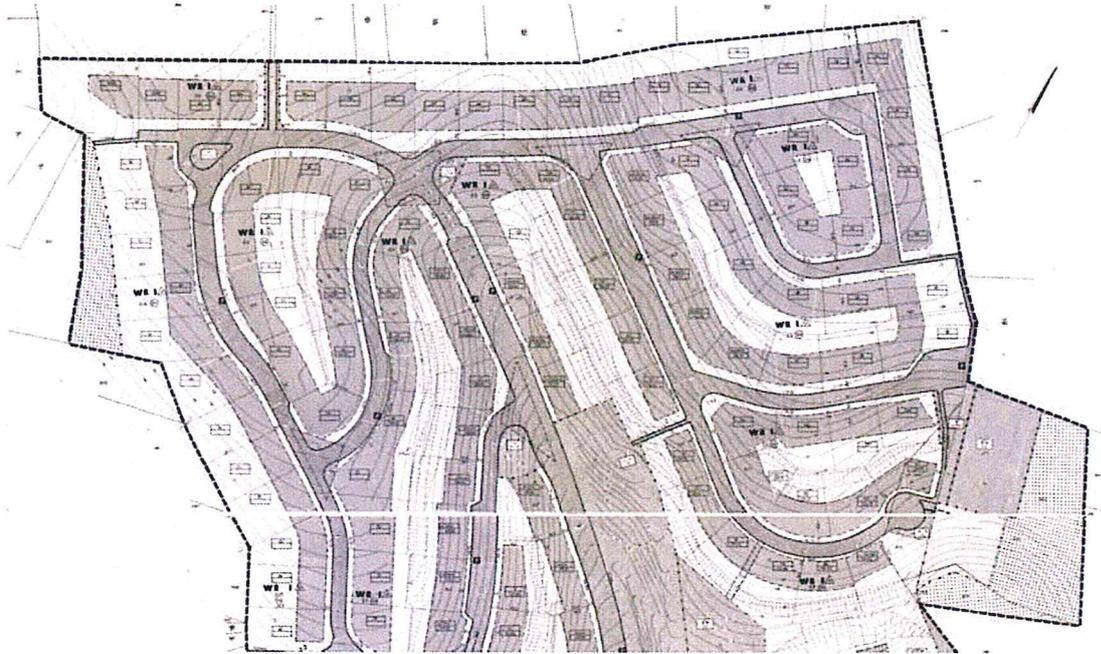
Ursprungsbebauungsplan 45 B-Osenau, Ausschnitt (ohne Maßstab), Gemeinde Odenthal
